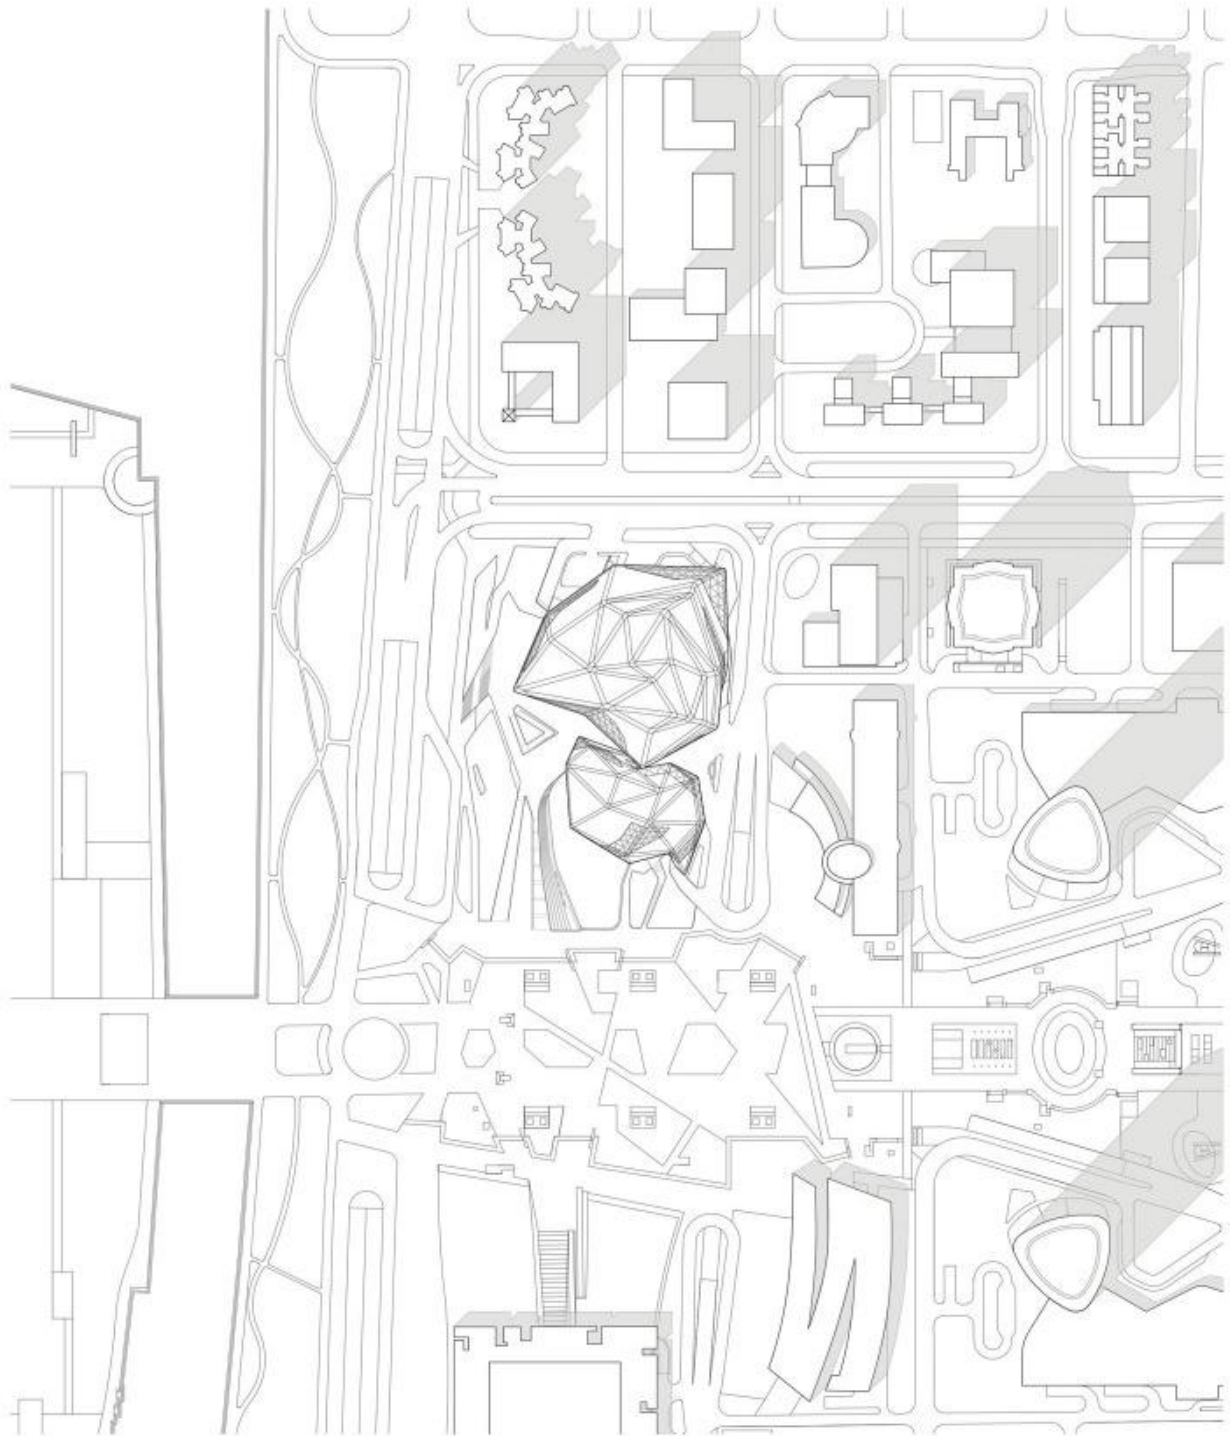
Casa da Ópera de Guangzhou, planta de Implantação.
